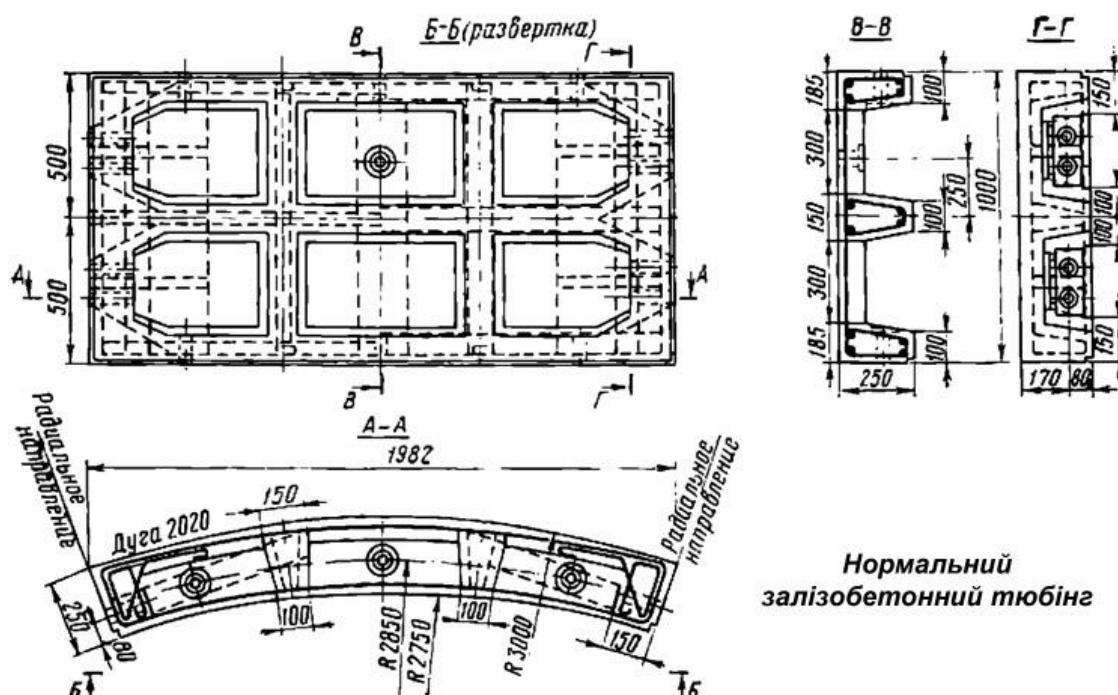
Конструкція нормального залізобетонного тюрінга
